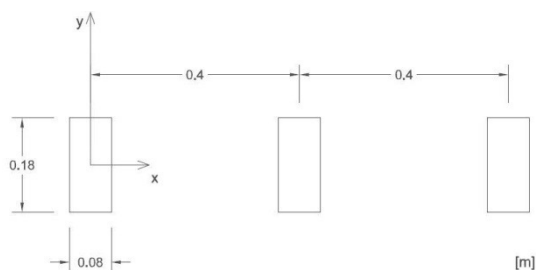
Secção do pavimento - eixos locais dos barrote [m] (Branco, 2005).
